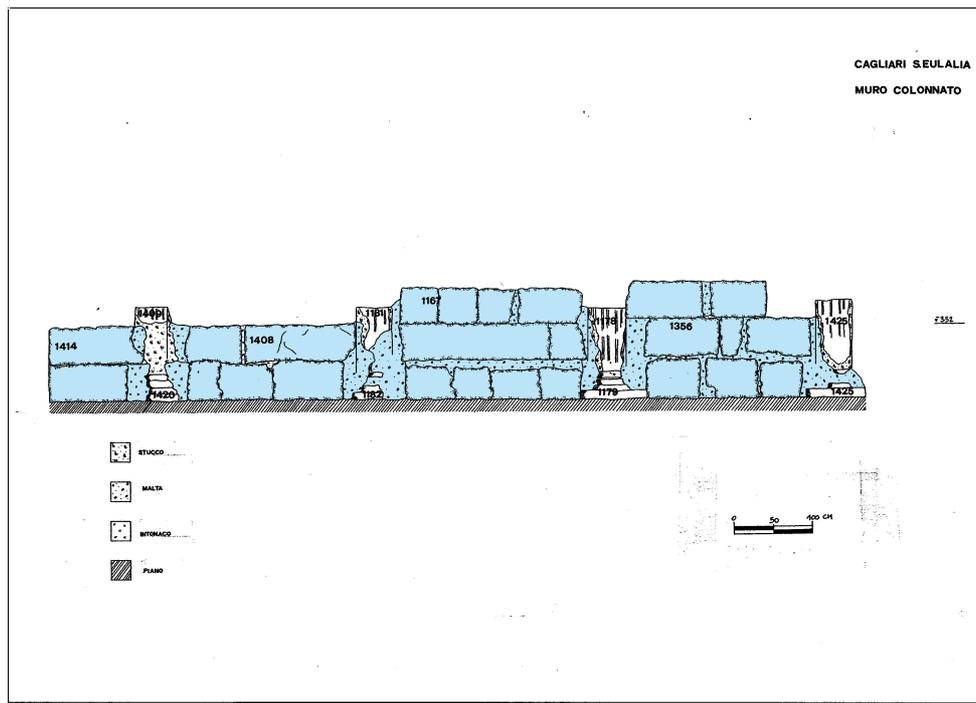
Unità stratigrafica muraria nell'archeologia delle strutture murarie: esempio di documentazione grafica di un prospetto murario.
